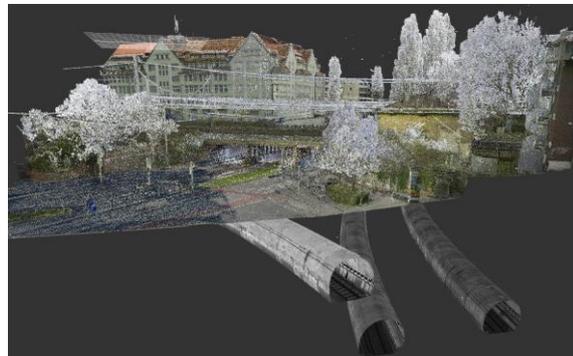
Ausschnitt Punktwolke terrestrisches Laserscanning + U-Bahntunnel
